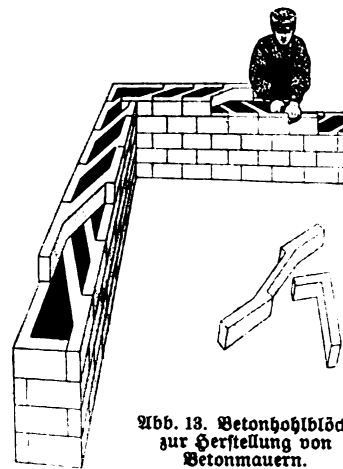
Betonhohlblöcke zur Herstellung von Betonmauern.
